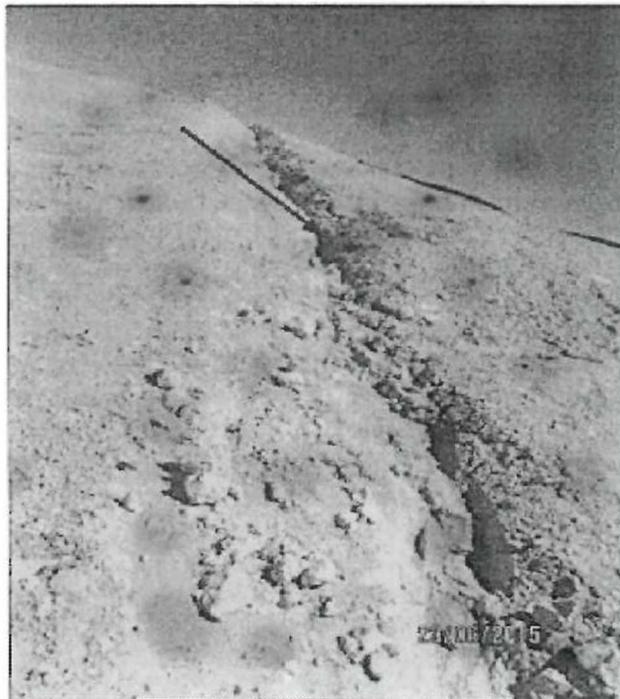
Vista de otro ángulo de canal de coronación en la cantera Sexi.
